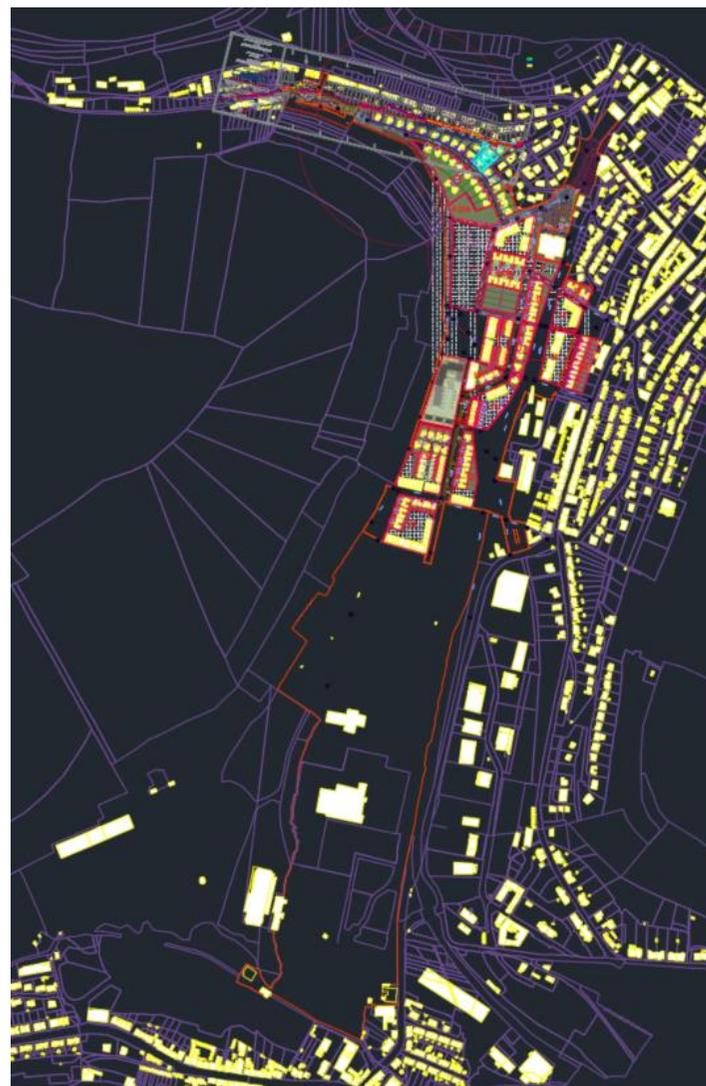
Plan masse du projet, 31 juillet 2023 (source : DCE provisoire)
